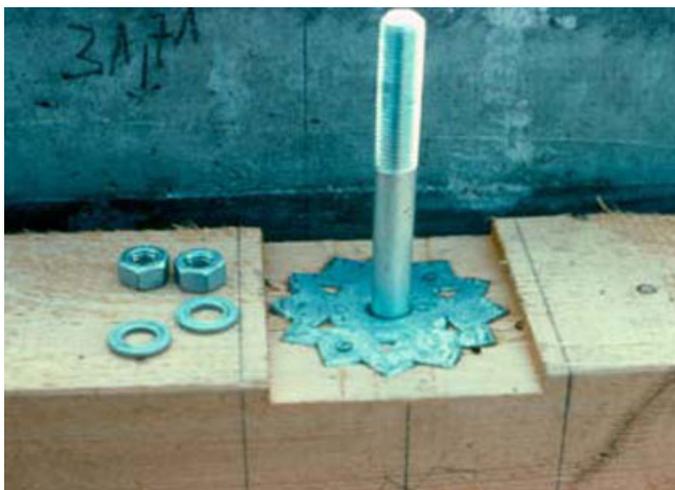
Einpressdübel (Bulldog) im eingepressten Zustand mit Bauschraube
